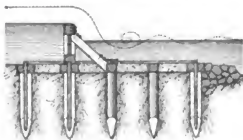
Holzernes Stufenwehr. M. 1 : 200.
